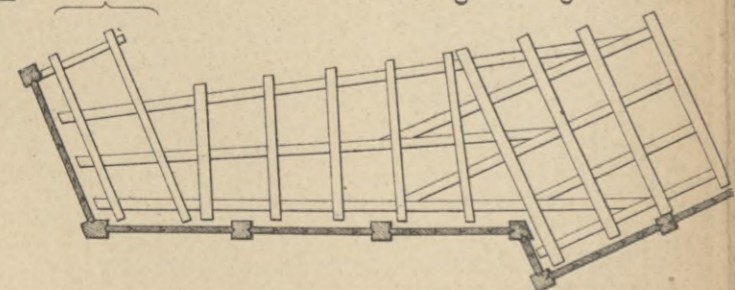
Rost für Widerlager mit schrägen Flügeln. A plan view diagram of a pile wall structure for an abutment with inclined wings.
